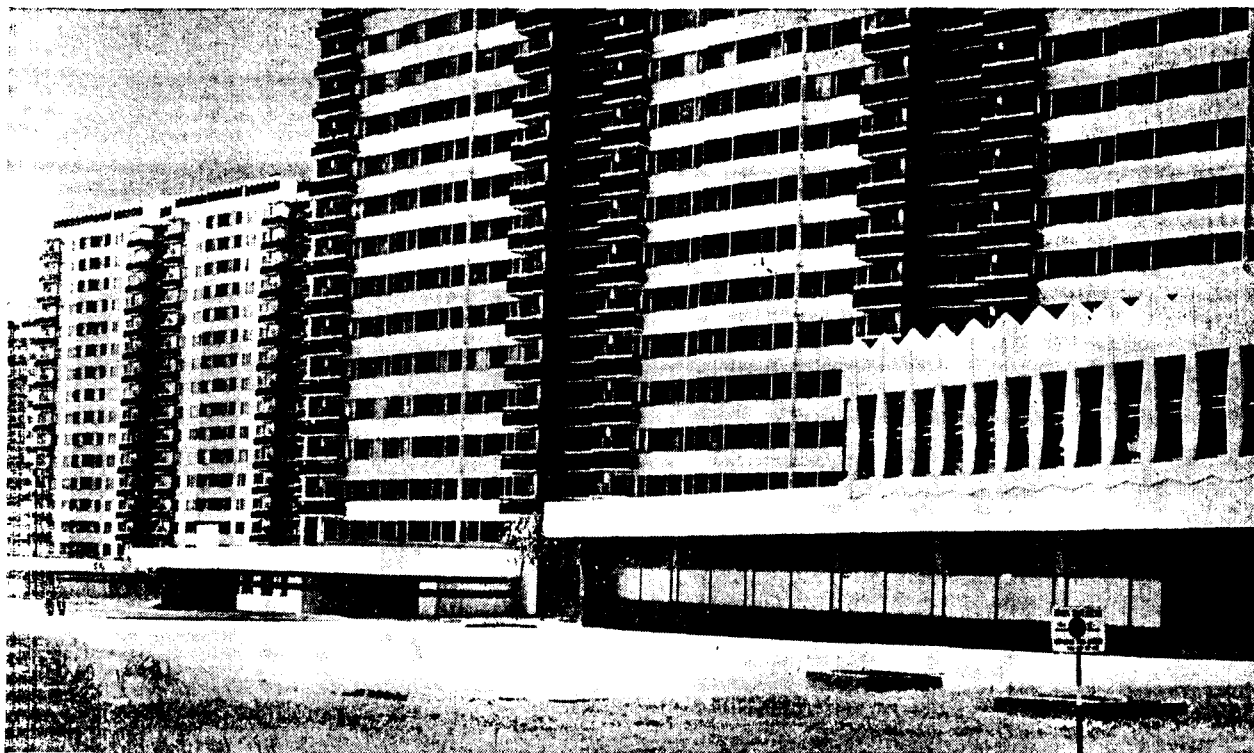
Архитектура крупнопанельного здания с усиленной пластикой фасада, созданной фактурой и цветом его элементов (Москва, Тропарёво)
